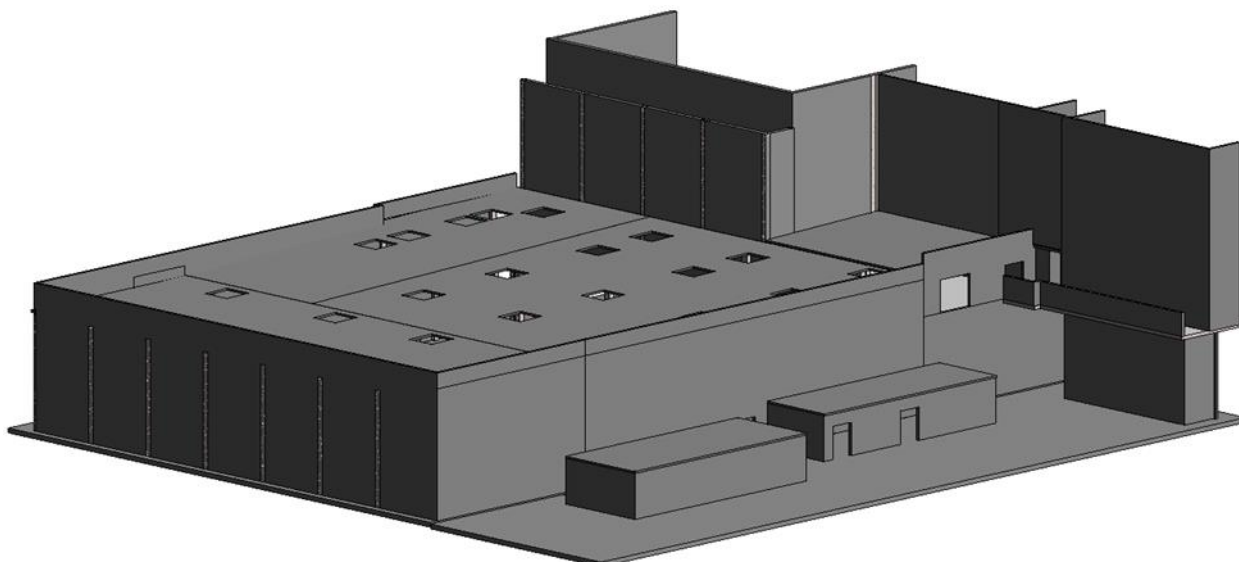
Modelo BIM com introdução de objetos referentes às lajes
